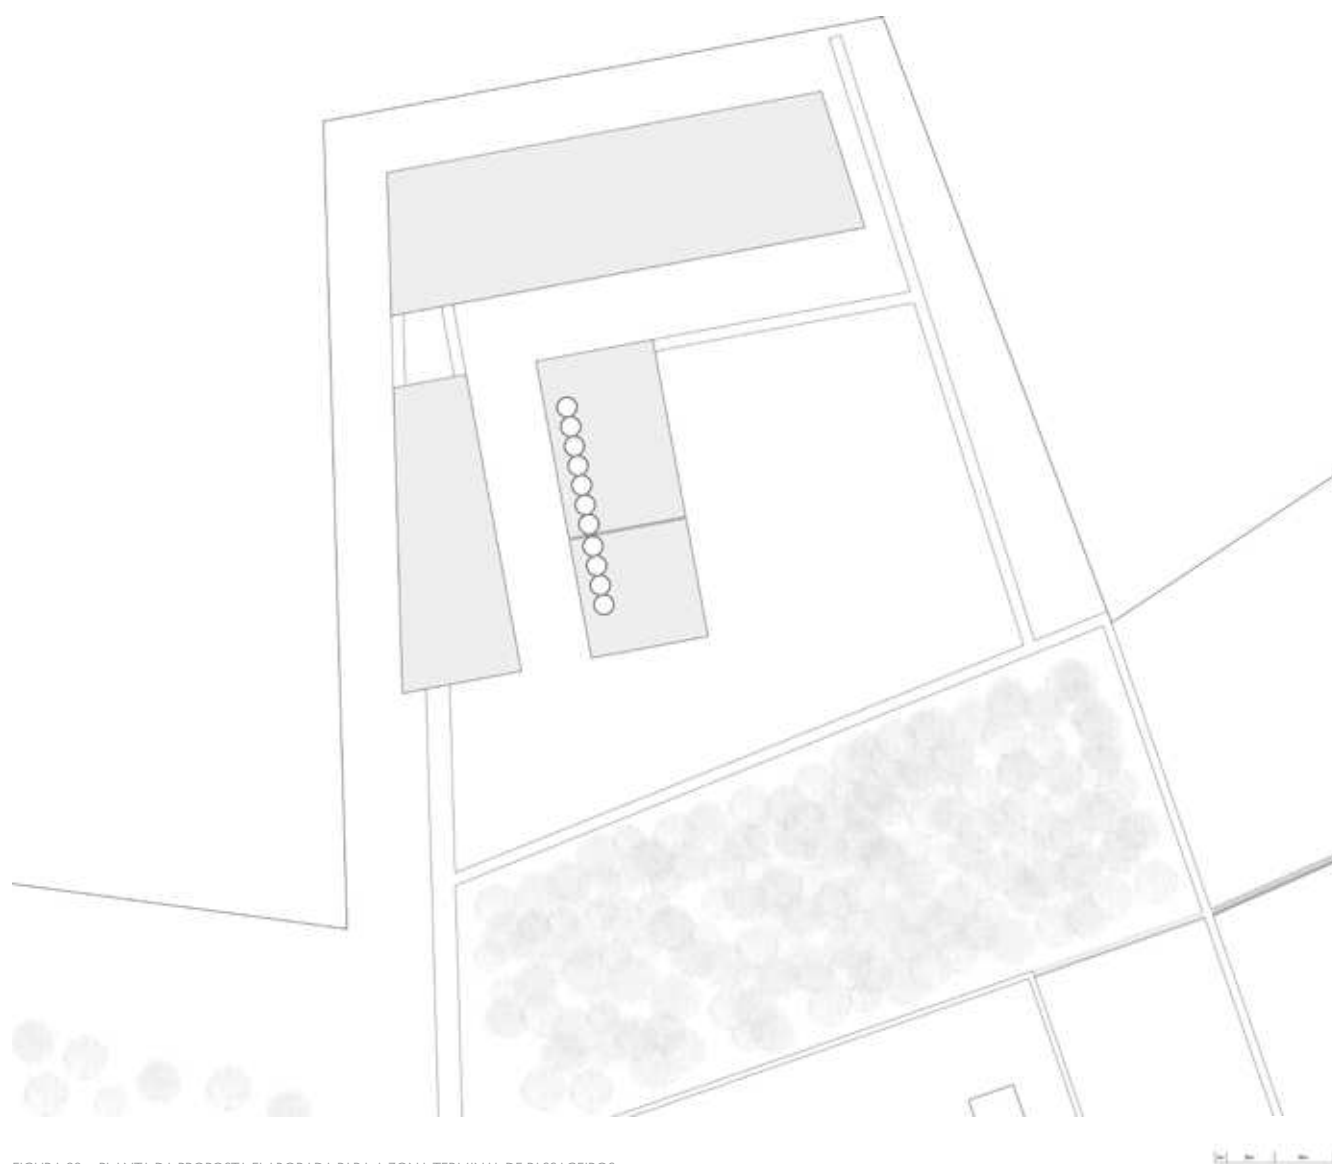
PLANTA DA PROPOSTA ELABORADA PARA A ZONA TERMINAL DE PASSAGEIROS
